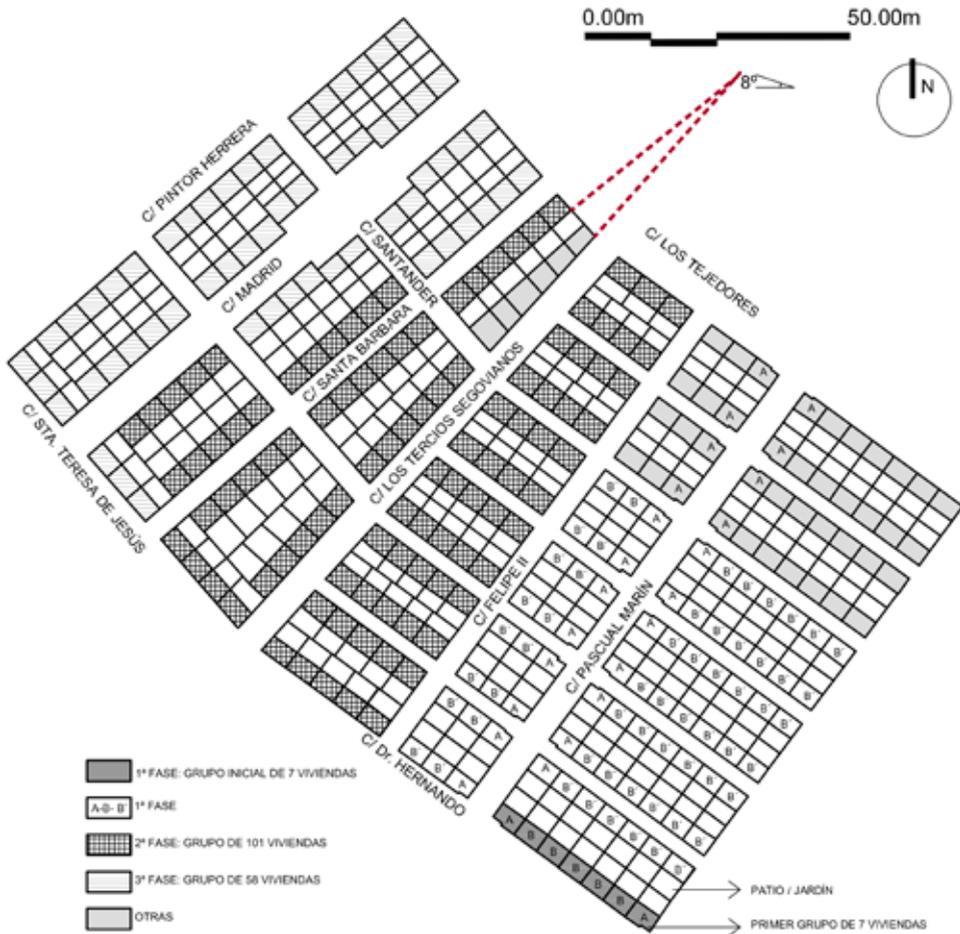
Localización de los tipos de viviendas de la primera fase.
